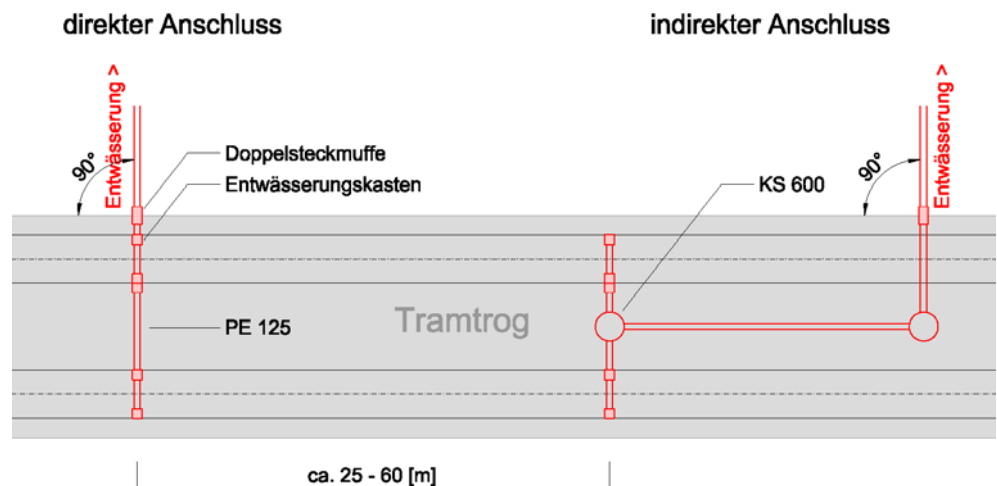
Schema Grundriss Gleisentwässerung
